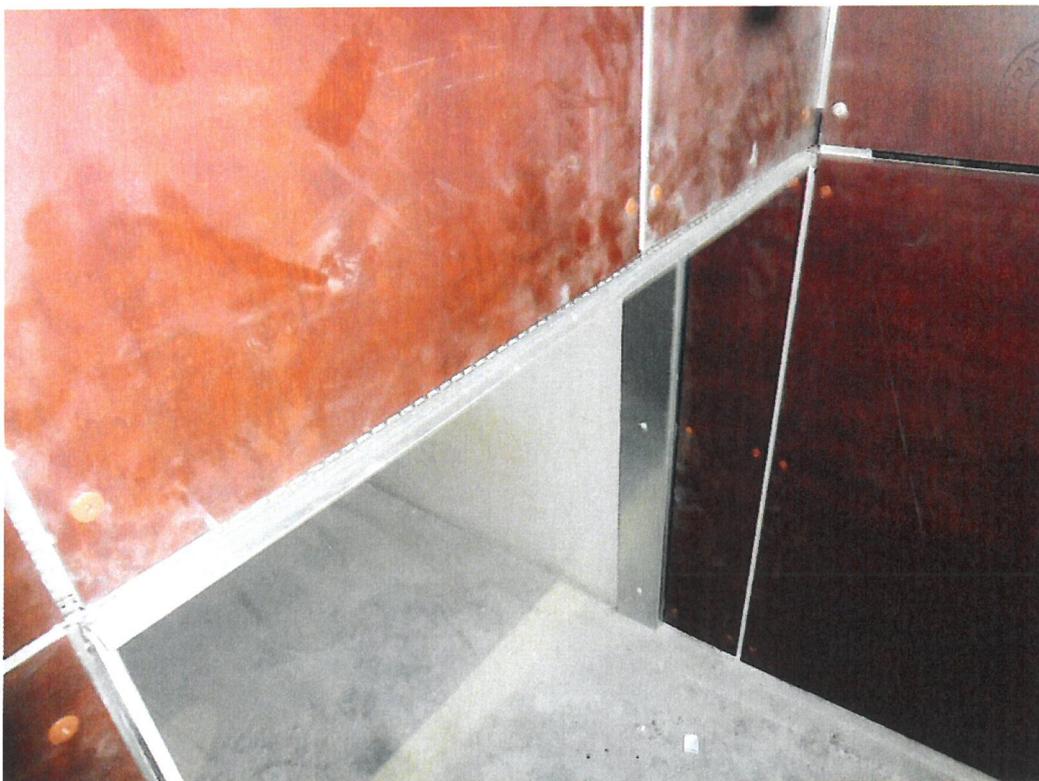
(P1110018): Detail Sturzbereich unmittelbar vor der Prüfung
